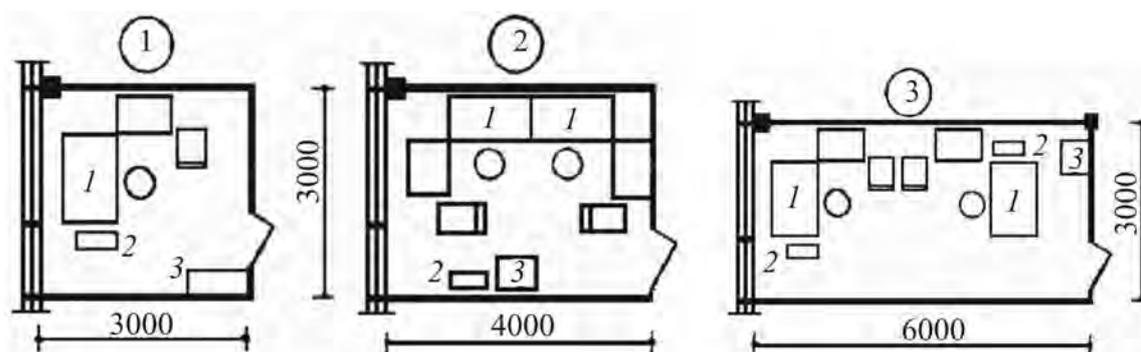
Помещения касс пересчета монет на 1 и 2 рабочих места: вариант 1 — помещение площадью  $9,0 \text{ м}^2$  на 1 рабочее место; вариант 2 — помещение площадью  $12 \text{ м}^2$  на 2 рабочих места; вариант 3 — помещение площадью  $18 \text{ м}^2$  на 2 рабочих места: 1 — рабочее место сотрудника кассы пересчета монет; 2 — контейнер для мусора; 3 — шкаф металлический
